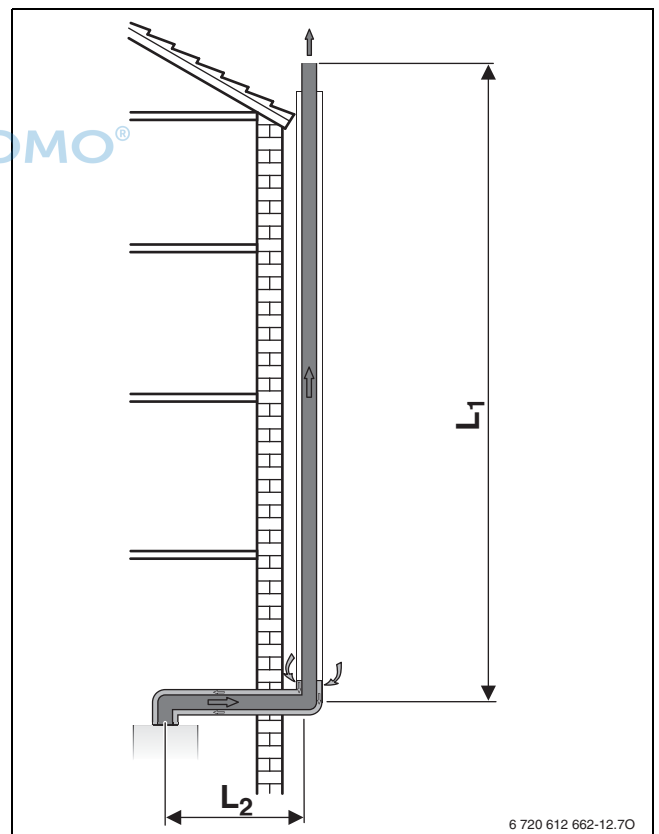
Abgasführung an der Fassade nach $C_{53(x)}$
